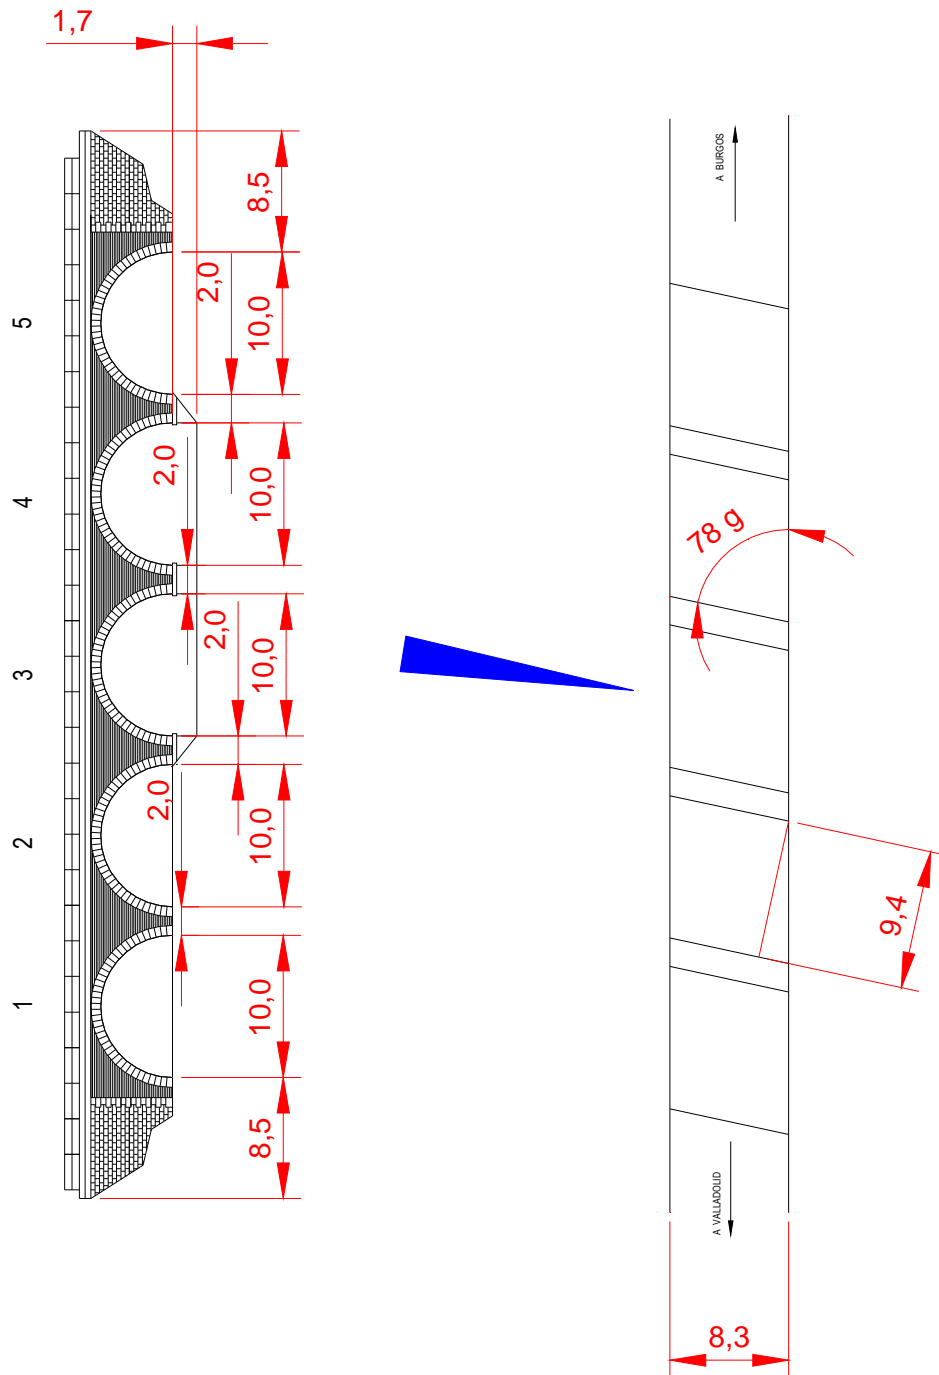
Planta y alzado de aguas abajo del puente del ferrocarril en Dueñas
